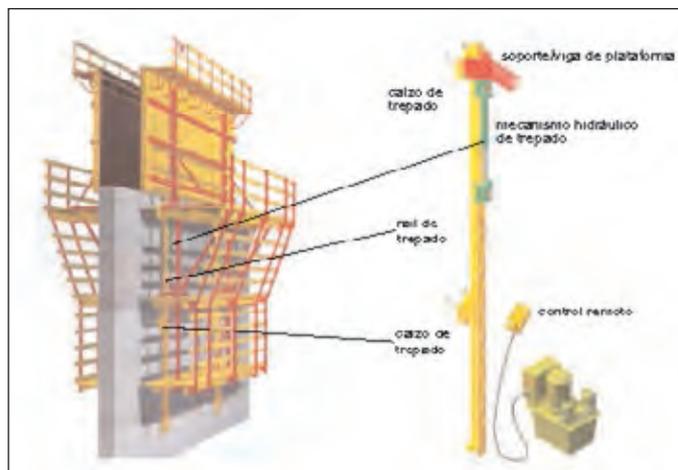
Encofrados autotrepante y detalle del equipo hidráulico
